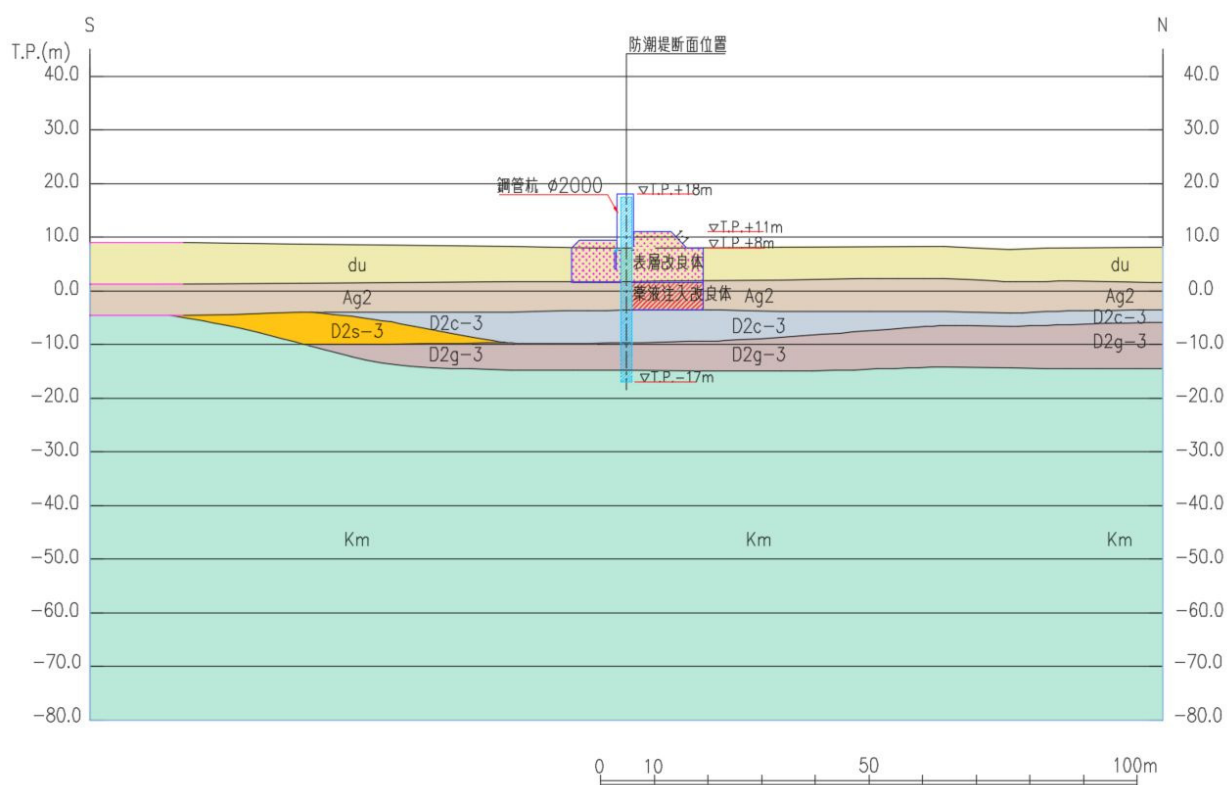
10. 5-29 (1) 鋼管杭鉄筋コンクリート防潮壁 断面図 (断面①)
